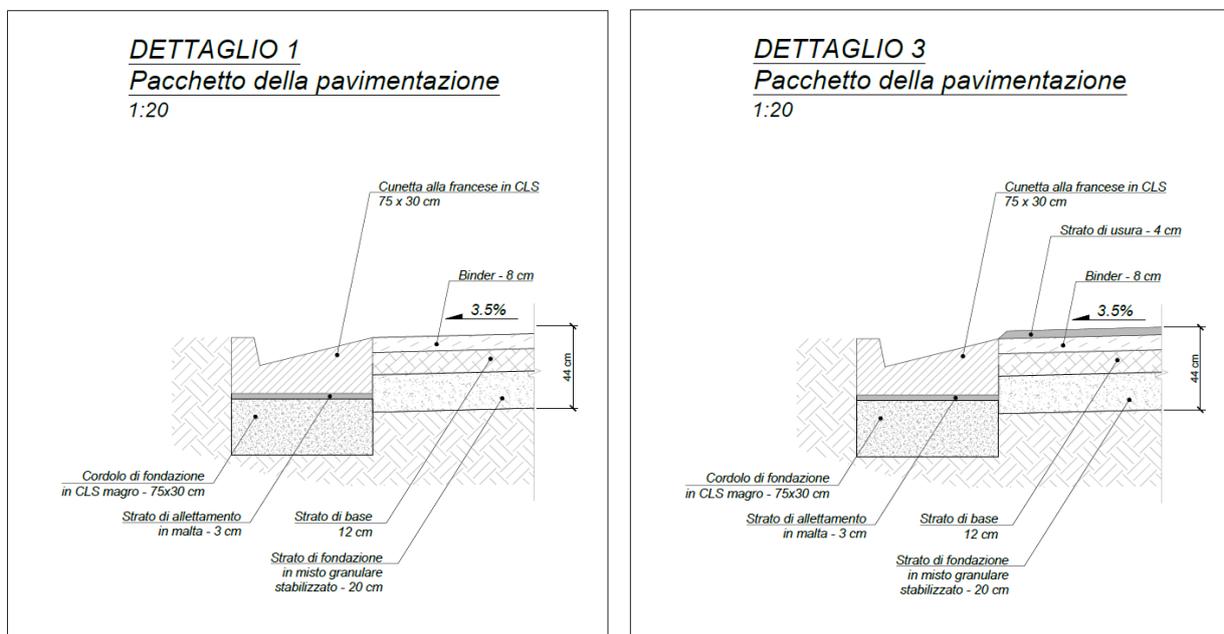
Dettagli della pavimentazione stradale: il dettaglio 1 fa riferimento alla porzione di rampa costruita sullo strato di Argilliti AMTa (a sinistra). Il dettaglio 3 fa riferimento alla porzione di rampa costruita sul terreno di riporto (a destra)
